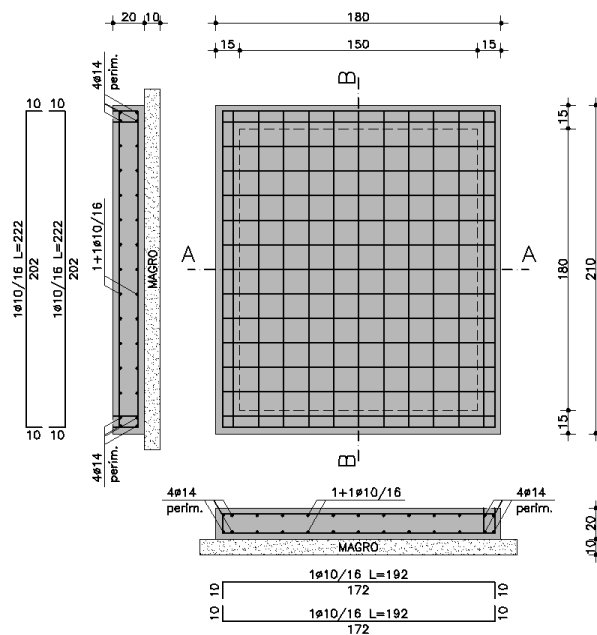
Pozzetto n. 1 - Sezione sul fondo
